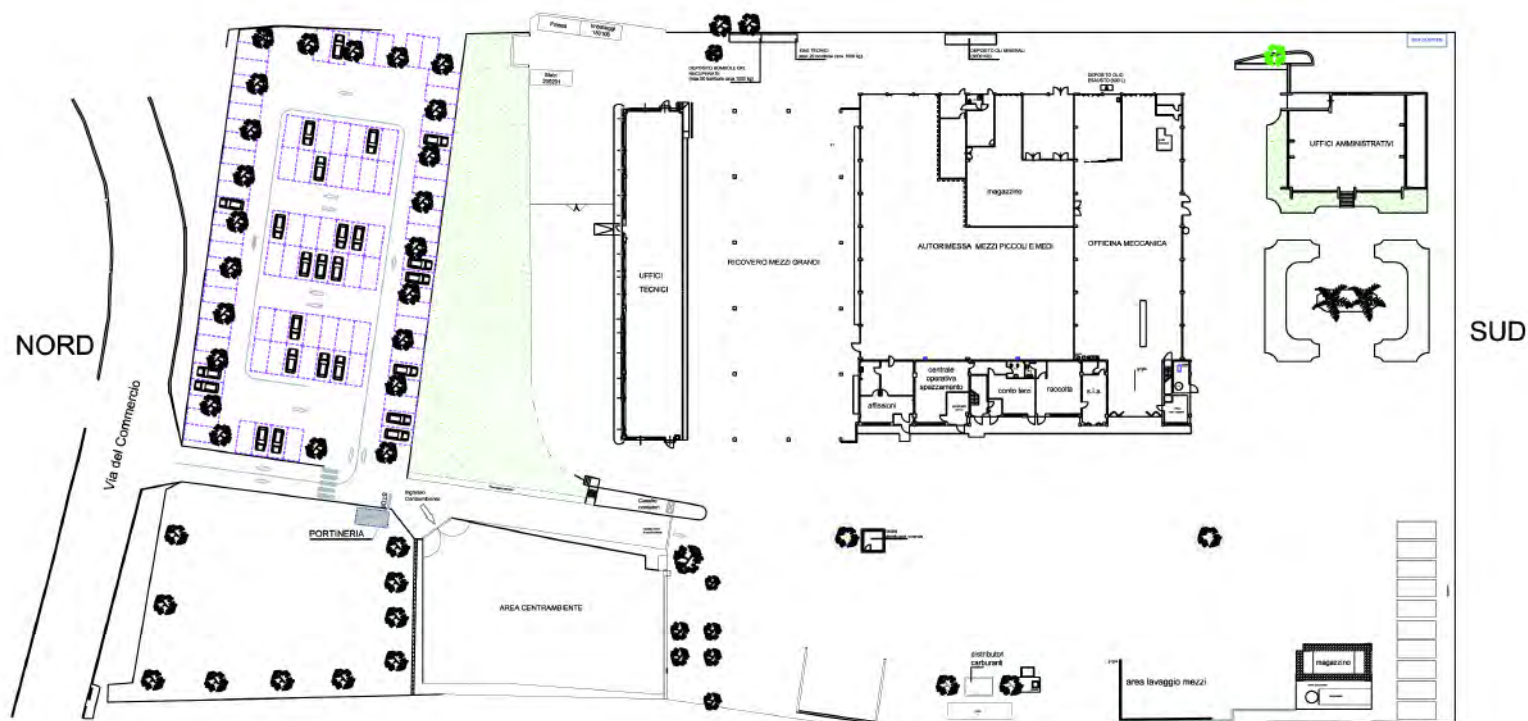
Planimetria AnconAmbiente SpA Via del Commercio, 27
